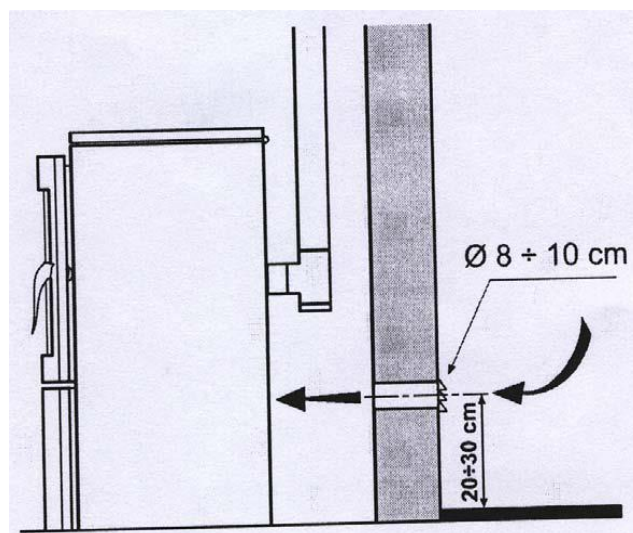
Deschizăturile minime pentru instalarea grilajelor de ventilație
